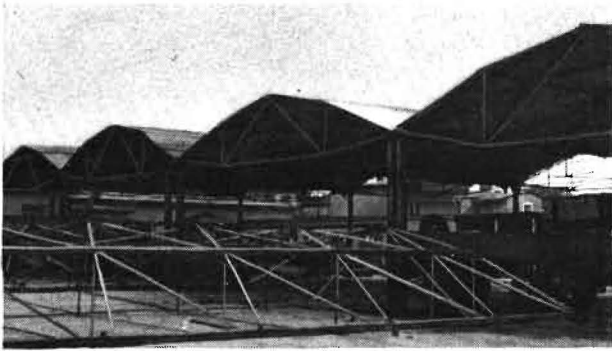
Stabnetzwerke mit 9×12 m Stützenabstand für Getreideschüttflächenüberdachungen. Im Vordergrund vormontierte Konstruktion
